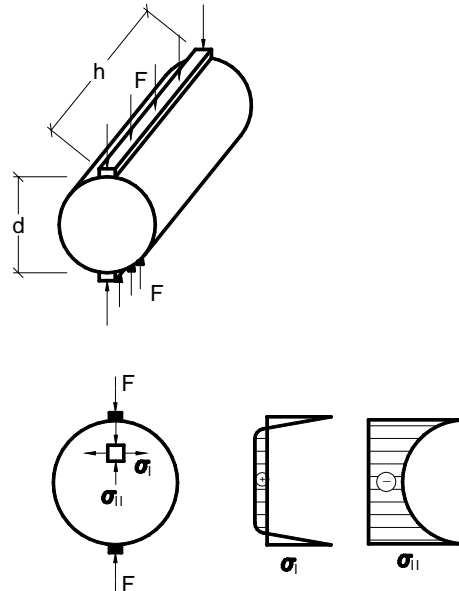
Resistência do concreto à tração determinada por ensaio de compressão diametral (SÜSSEKIND, 1985).
